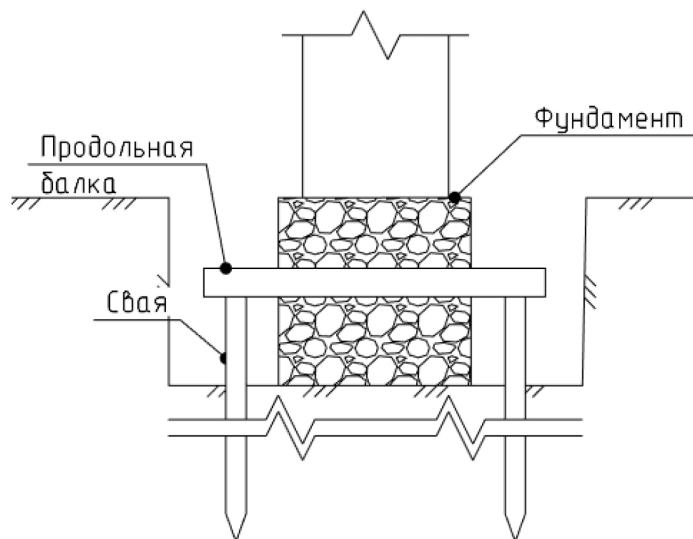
Усиление фундамента с помощью устройства выносных свай
